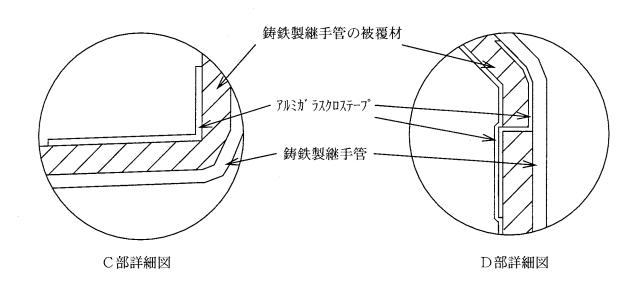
延焼防止材付鋳鉄製継手管の被覆部詳細図
